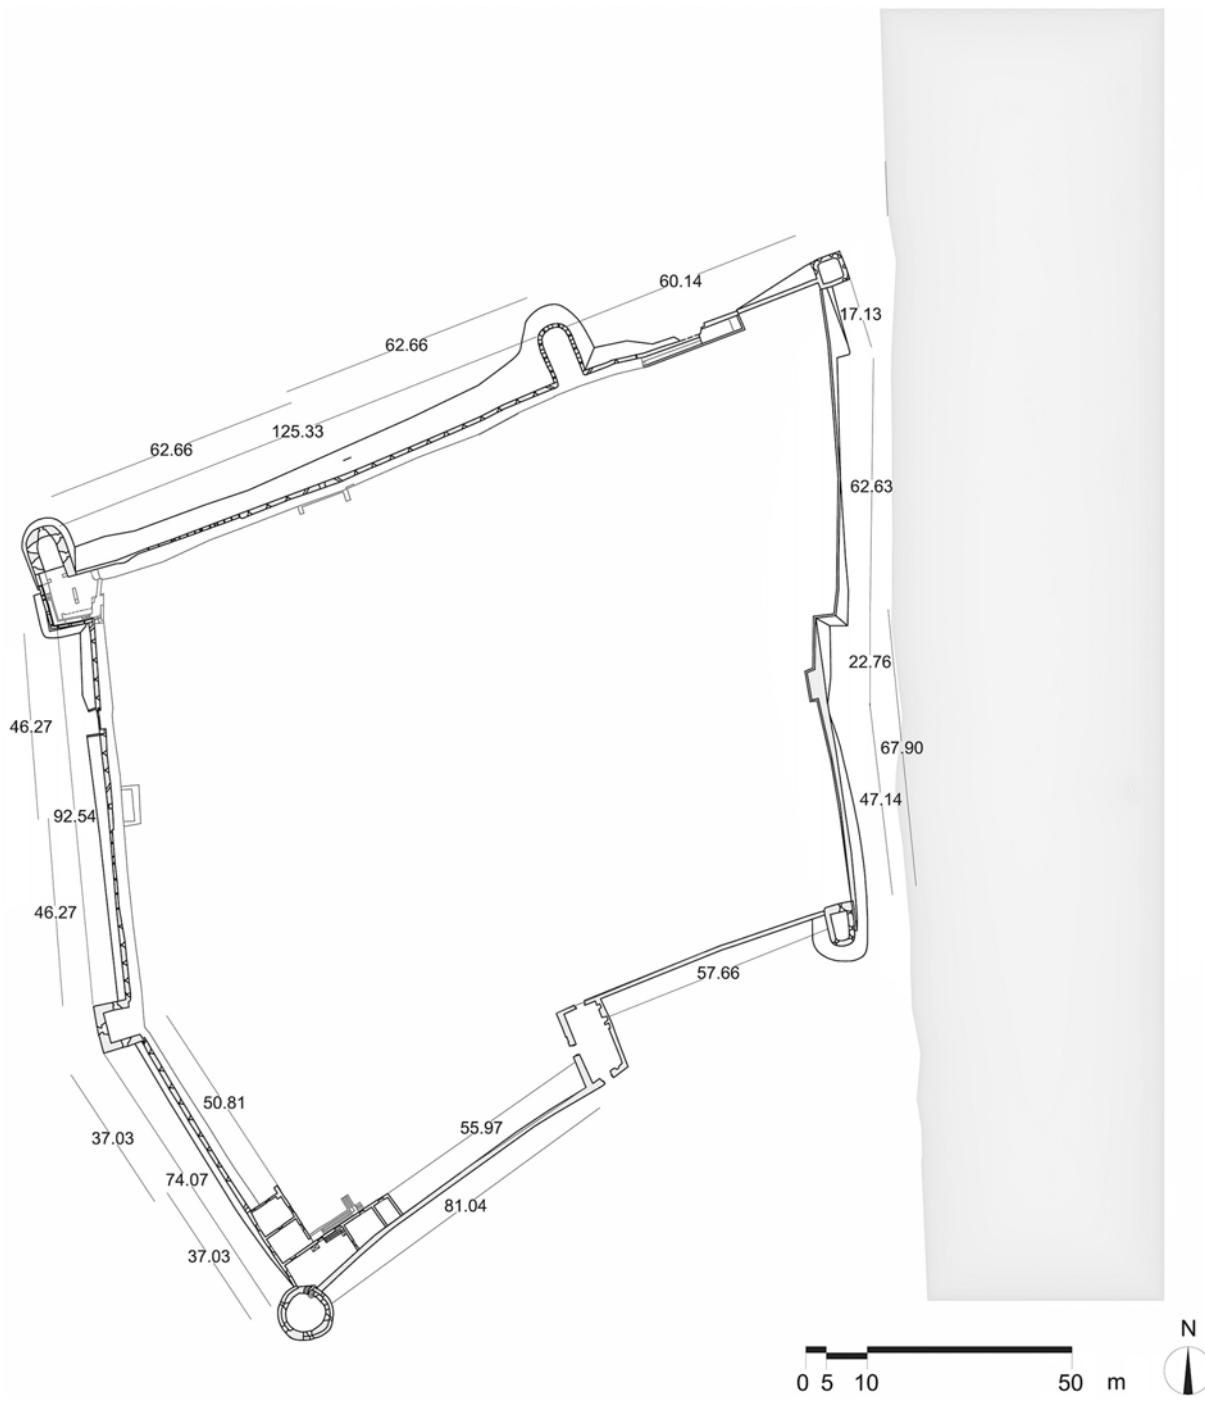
Planta do castelo português, com indicação de medidas entre estruturas notáveis. / Plan du château portugais, avec l'indication des mesures entre les structures remarquables.
